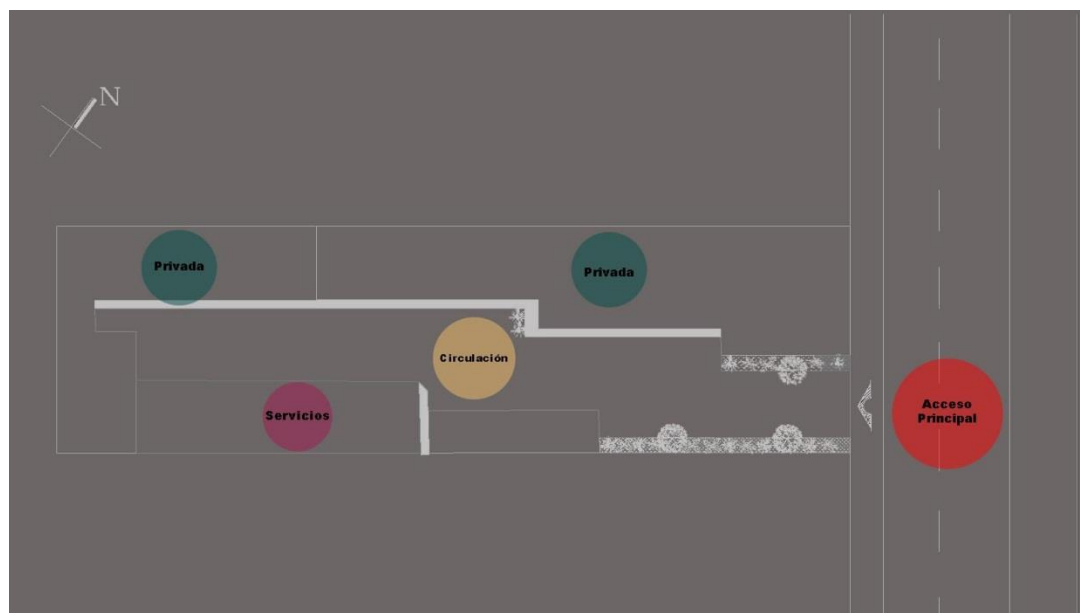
Planta baja, Fuente: Elaboración propia (18 de marzo 2018)
